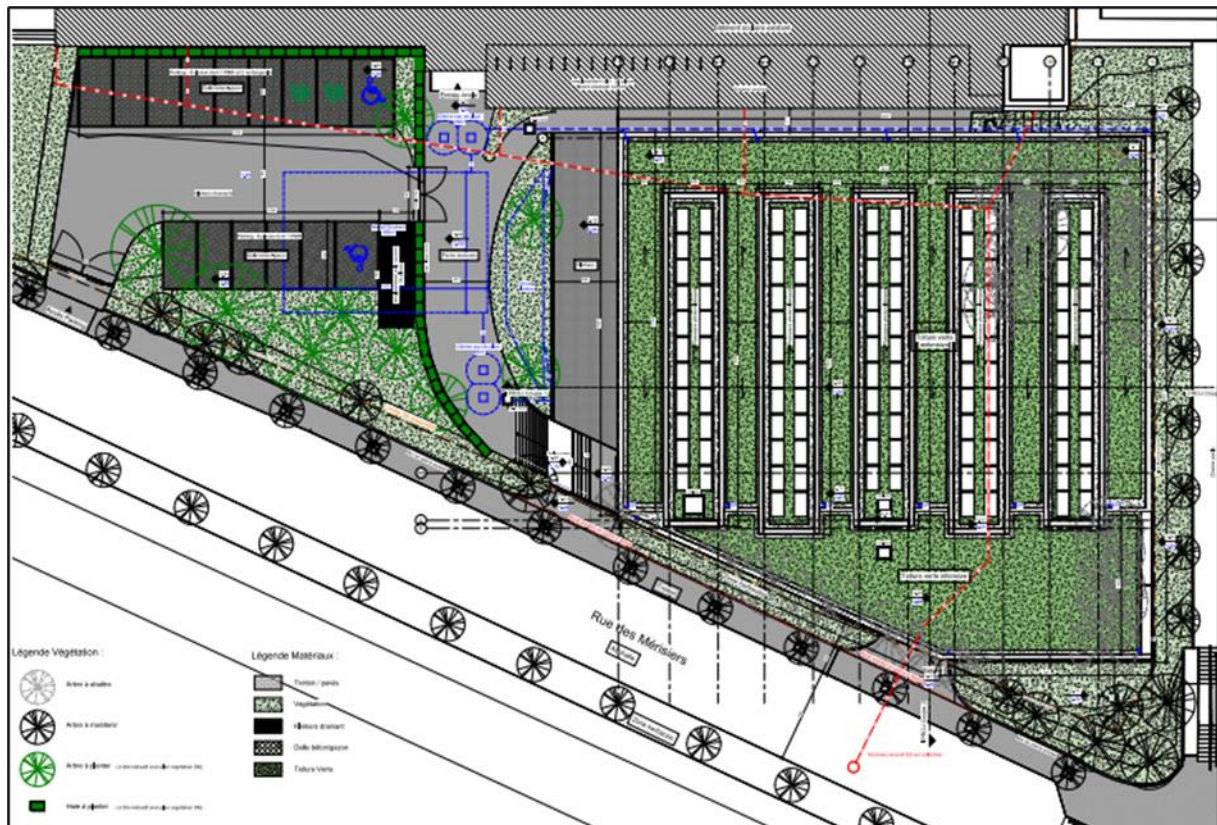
Plan d'implantation – situation projetée (Source : [REDACTED])
